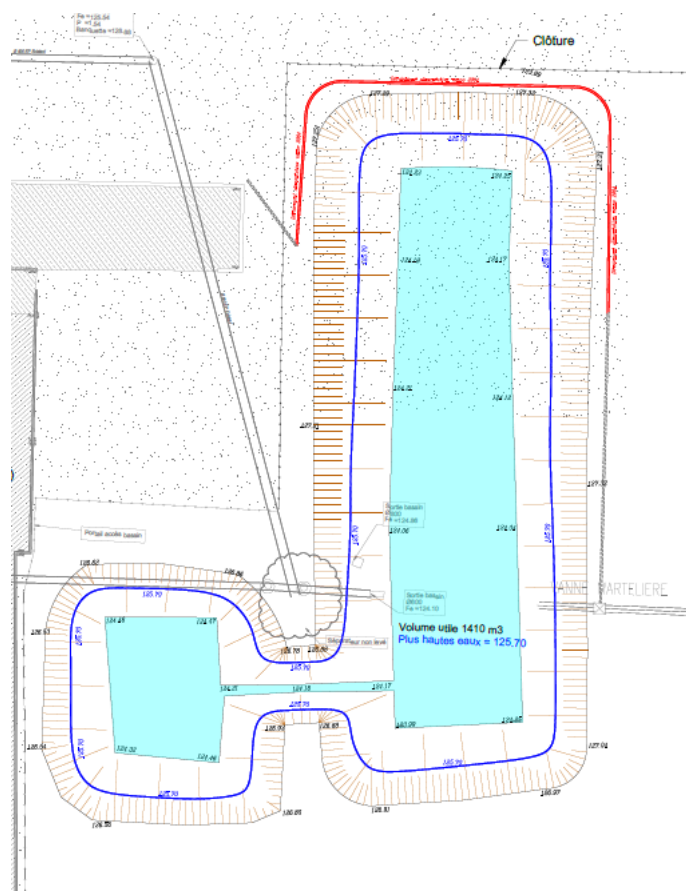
EXTRAIT DU DOE - PLAN DE RECOLLEMENT VRD
